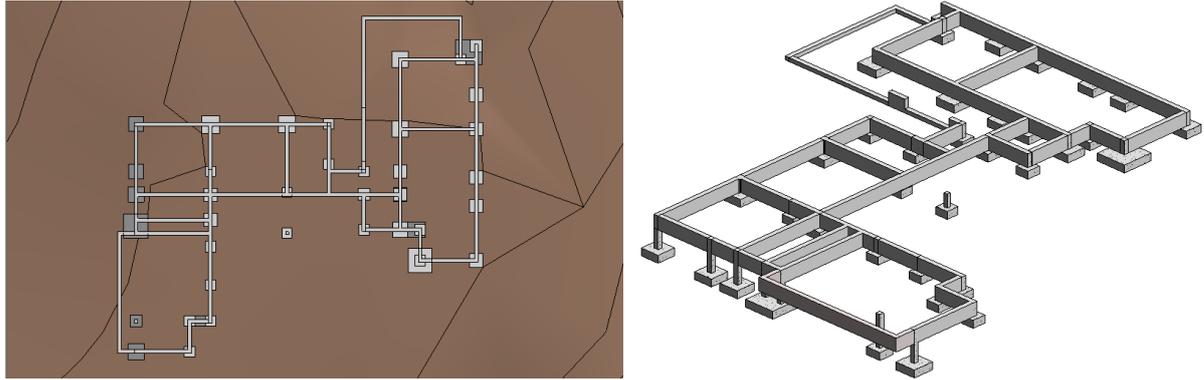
Elementos de fundação do projeto de execução, Revit
